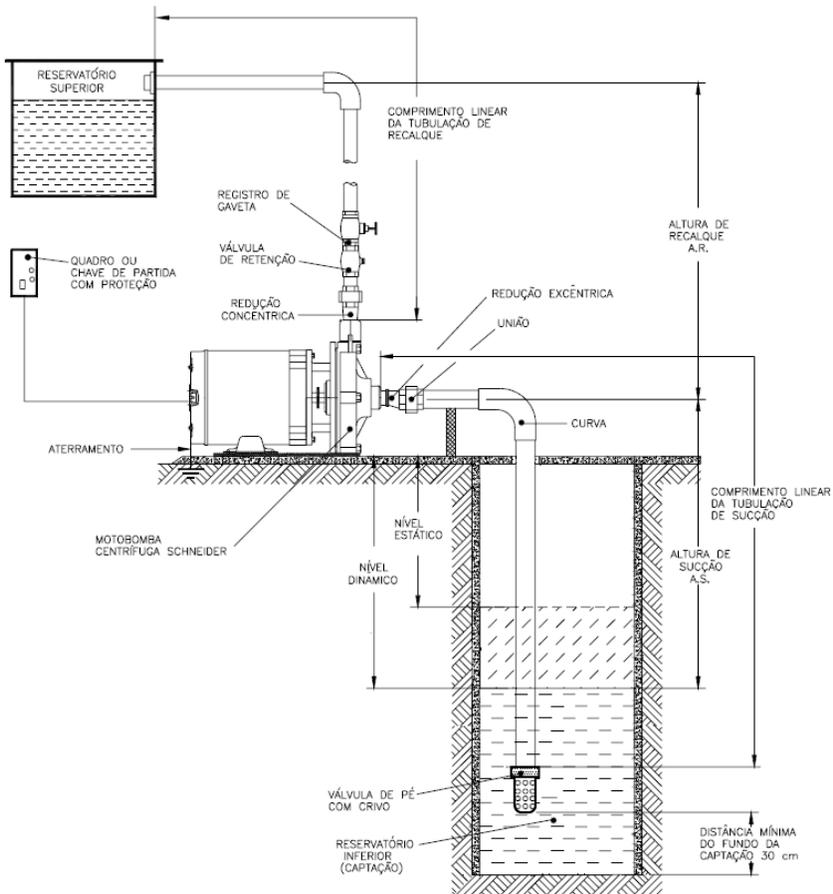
Esquema típico de instalação de um conjunto motor-bomba.
